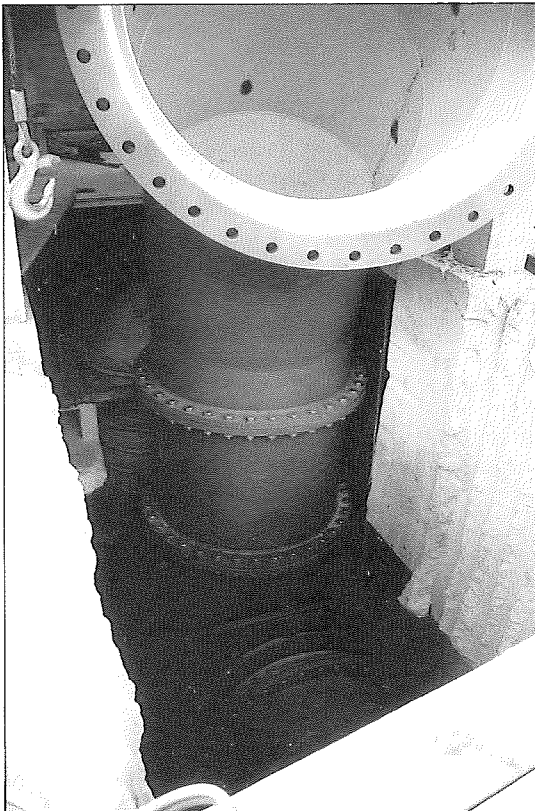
Tubería de aspiración. Estación de bombeo de San Juan (N.º 1).
